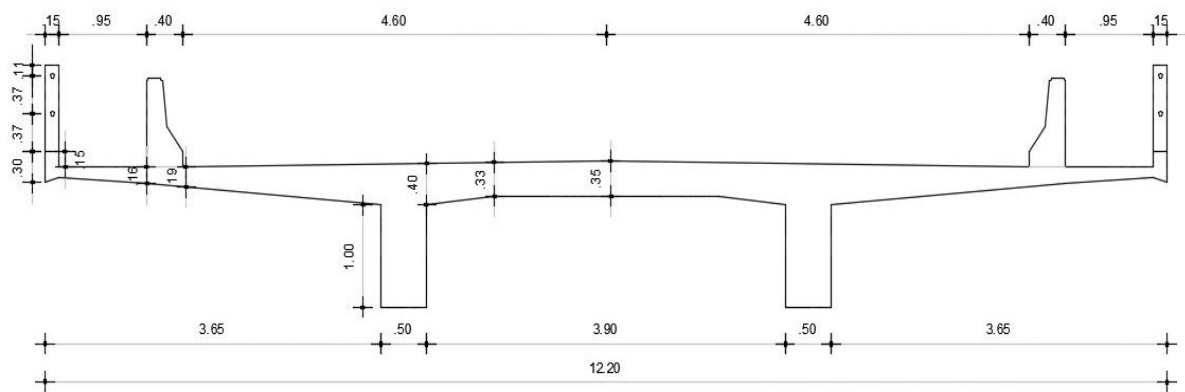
Superestrutura da ponte. Fonte: Próprio Autor
